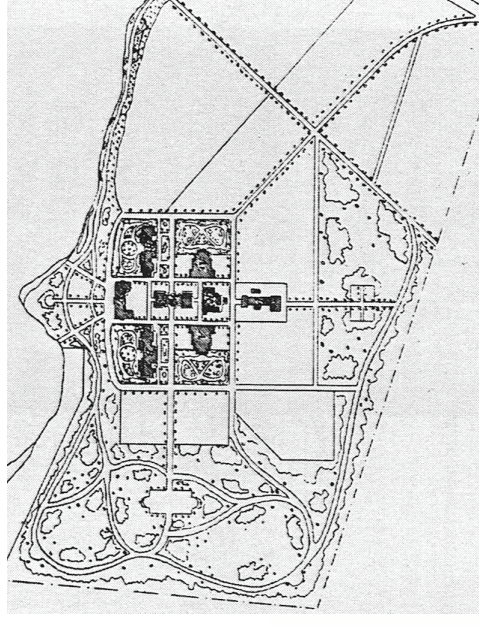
Lageplan Heil- u. Pflegeanstalt Domjüch, 1903
